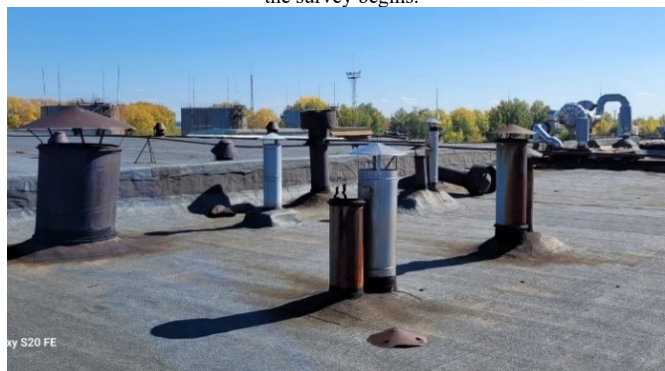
Следы выбросов паров химических реагентов систем технологических вытяжных вентиляций В9-В12 на кровле здания.
